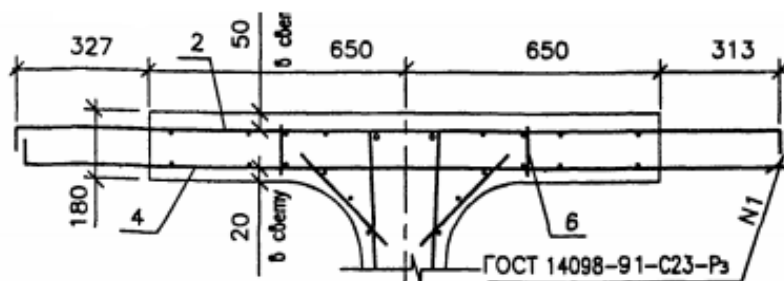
Армирование полки балки Б1500.130.93-Т28АШс
